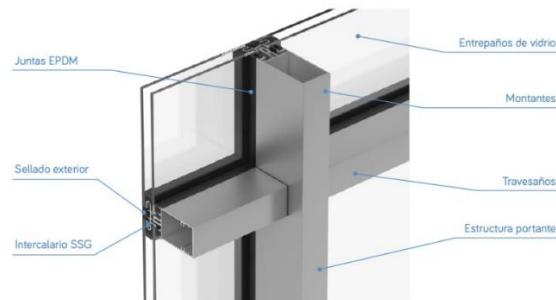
Muro cortina. Sistema de vidrio estructural en fachadas (fuente: Glasstech, 2017)
